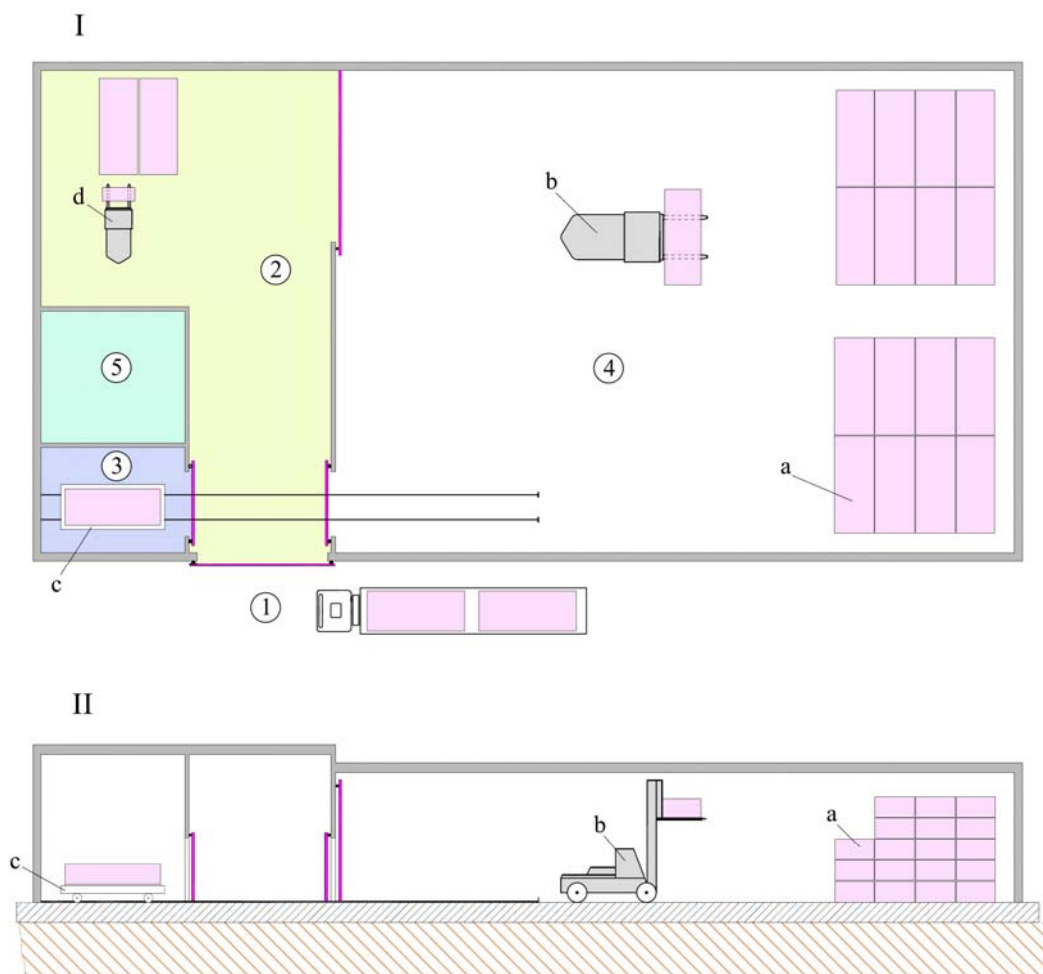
Концептуальный план буферного хранилища: вид с верху (I) и разрез (II):
